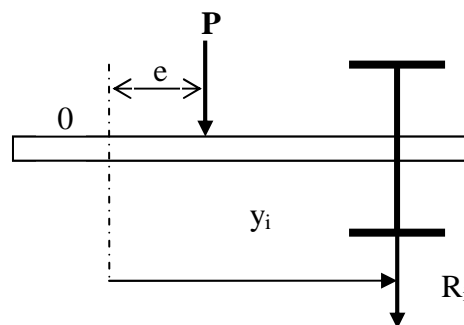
Réactions de l'entretoise sur la poutre  $i$
